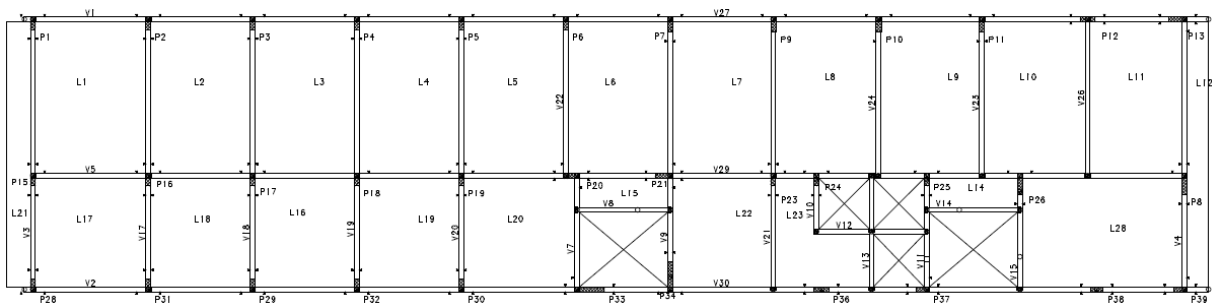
Lançamento preliminar do pavimento tipo. (Fonte: Autor, 2023)
